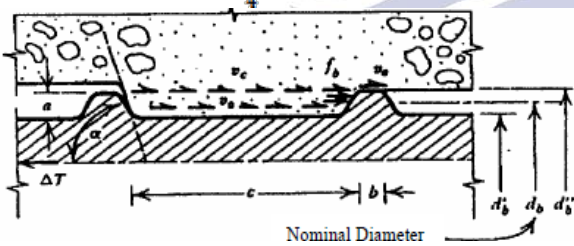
Panjang penjangkaran baja tulangan pada struktur.
